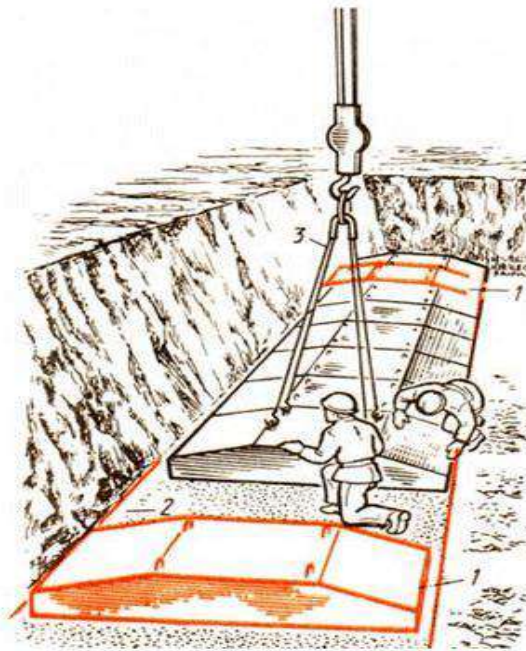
Монтаж фундаментных плит ленточного фундамента
